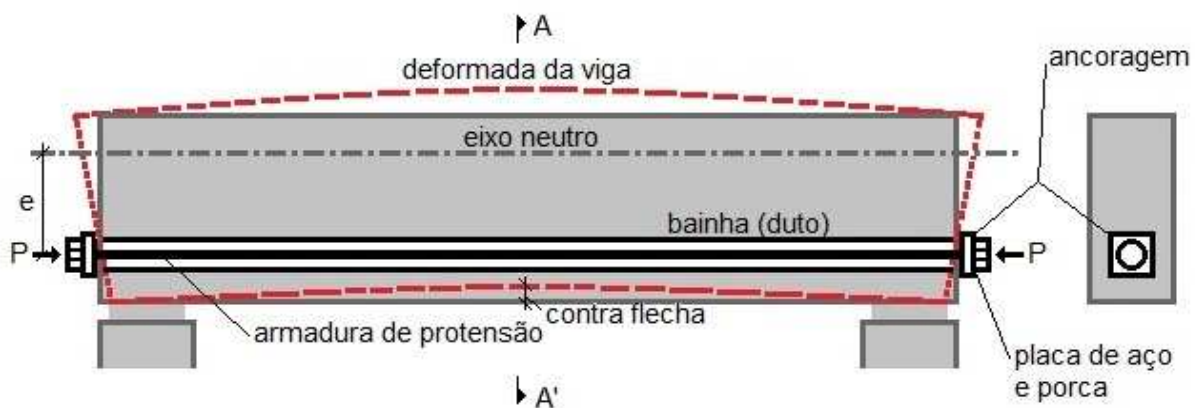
Esquema de viga protendida. Fonte: Carneiro (2007).
